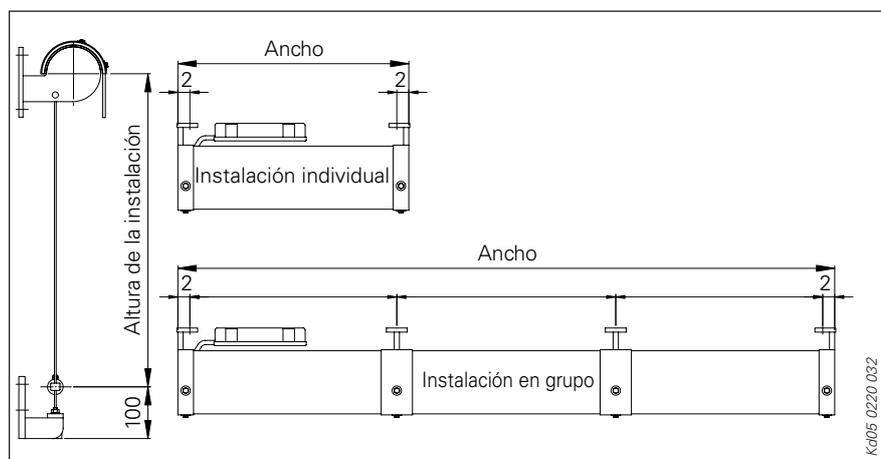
Guía de medidas Toldo para fachadas modelo 209 – guía de cable/varilla
